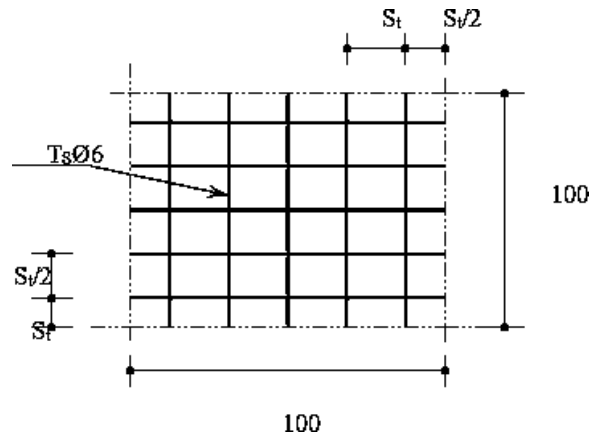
Disposition constructive des armatures de la dalle de compression.
